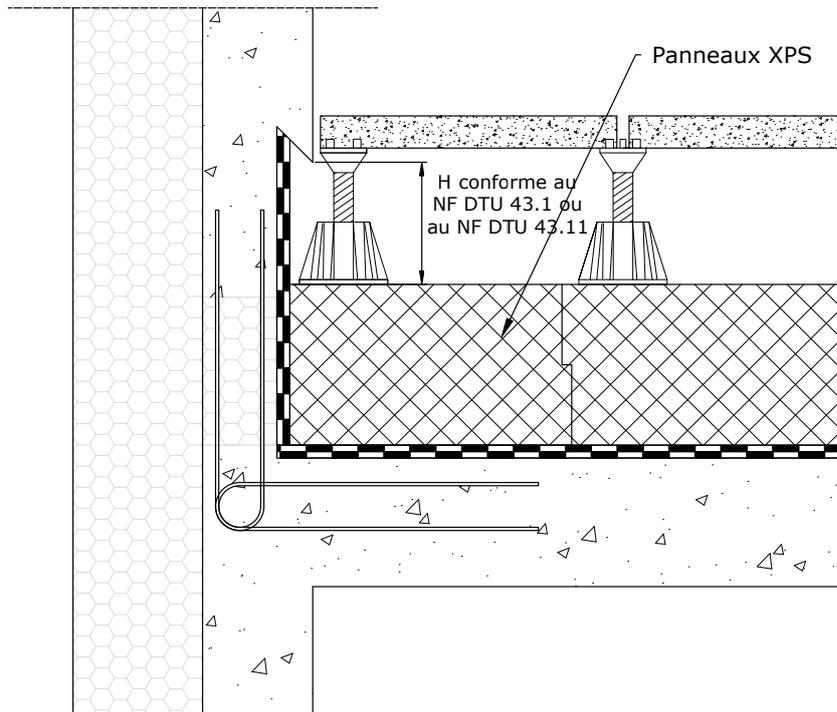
Toiture-terrasse accessible aux piétons avec protection par dalles sur plots - Exemple
